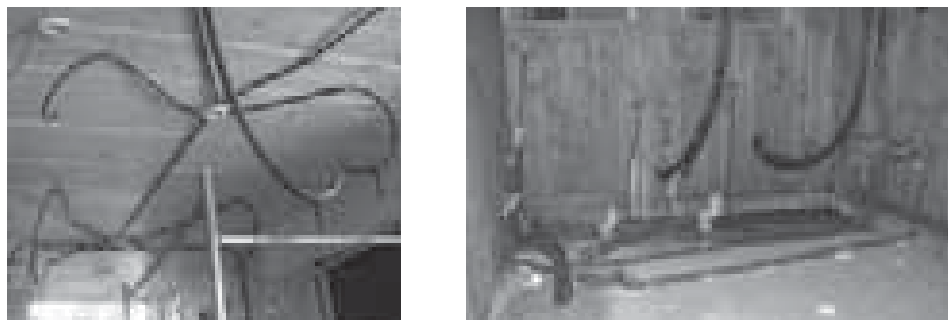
Posizionamento degli impianti a soffitto e sull'intercapedine interna della parete.
